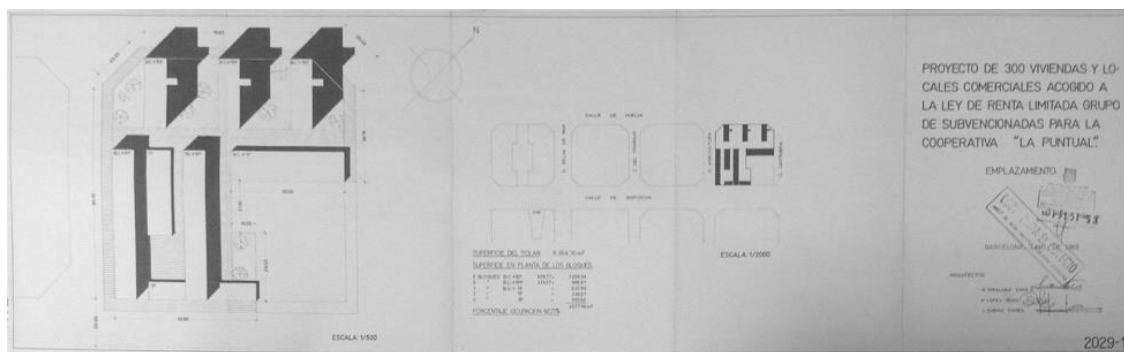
Emplazamiento del Conjunto, 1964. (Fuente: Fondo Giráldez – Archivo COAC).
